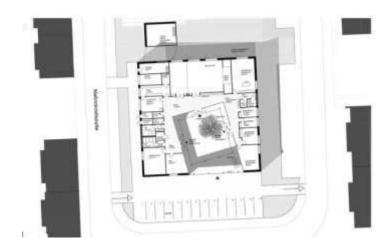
planta arquitectónica altenessen Tomada de Archdaily
